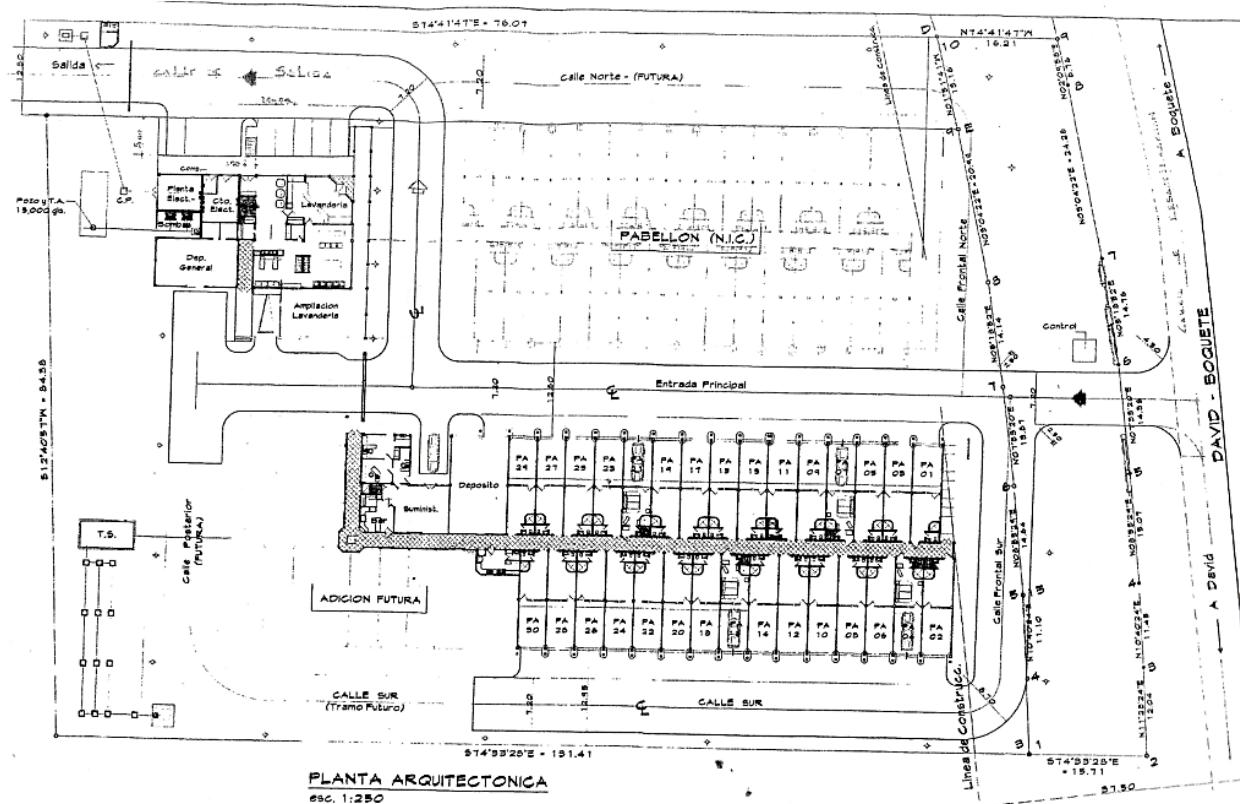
Planta arquitectónica del proyecto sobre el lote. Proyecto “AUTO MOTEL”, Los Algarrobos, Chiriquí. 2023
